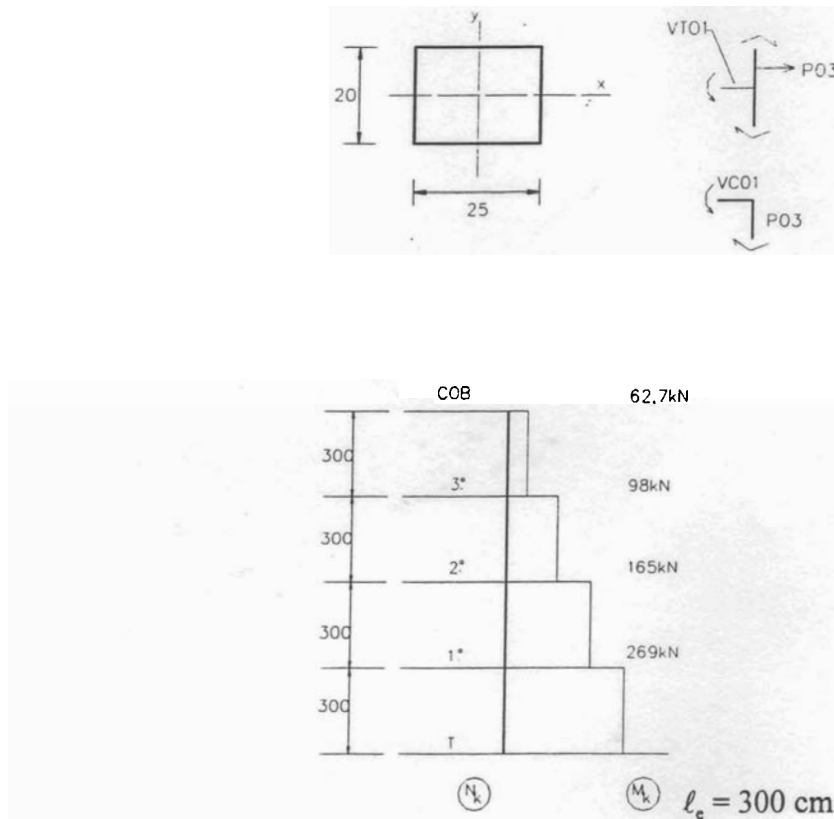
Somatória de ações nos pavimentos e seção transversal do pilar
